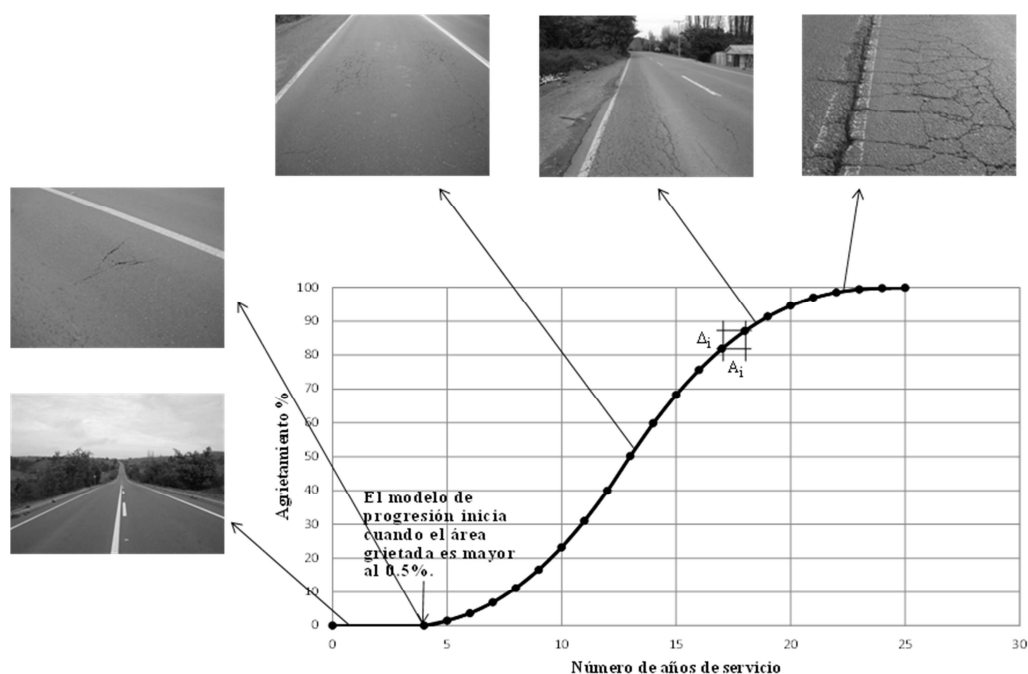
Modelo de agrietamiento para pavimentos.
